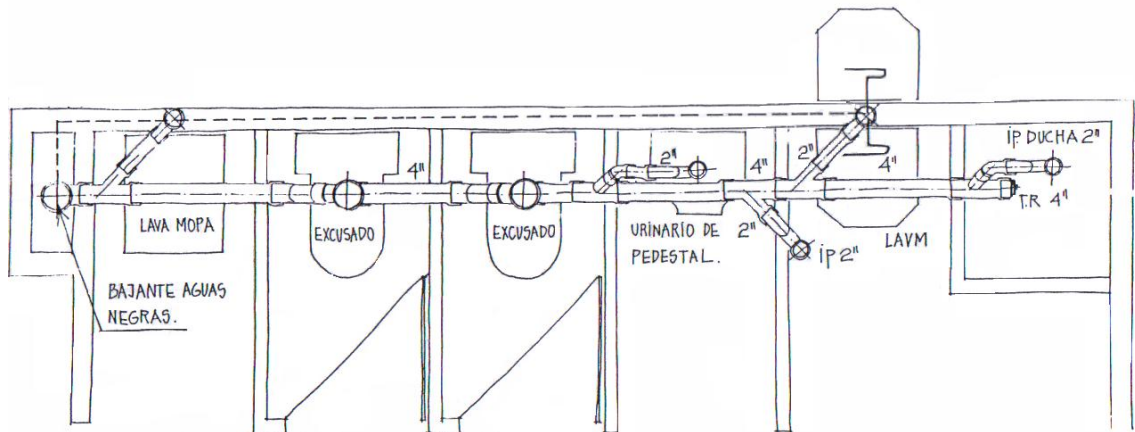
Ventilación en Conjunto con ventilación común - Planta
